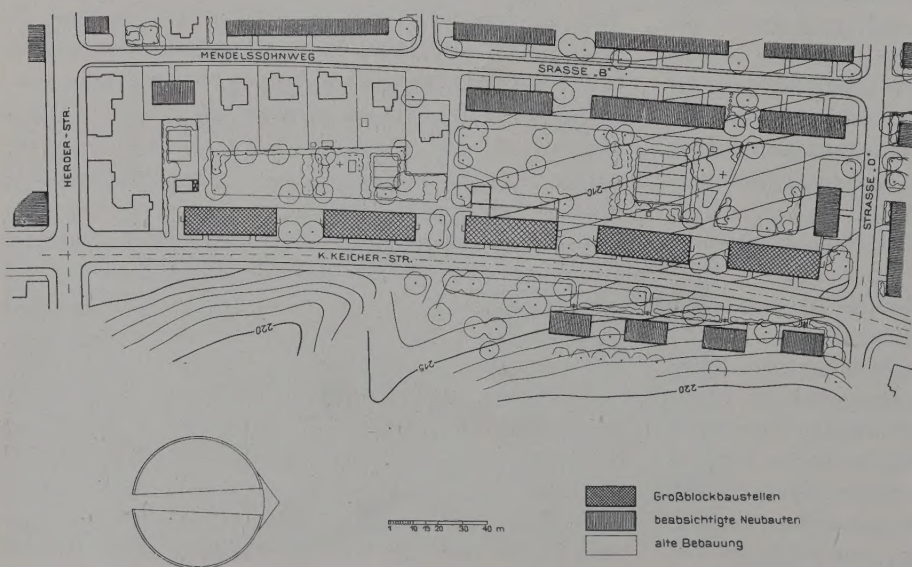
Lageplan Gera, Kurt-Keicher-Straße
